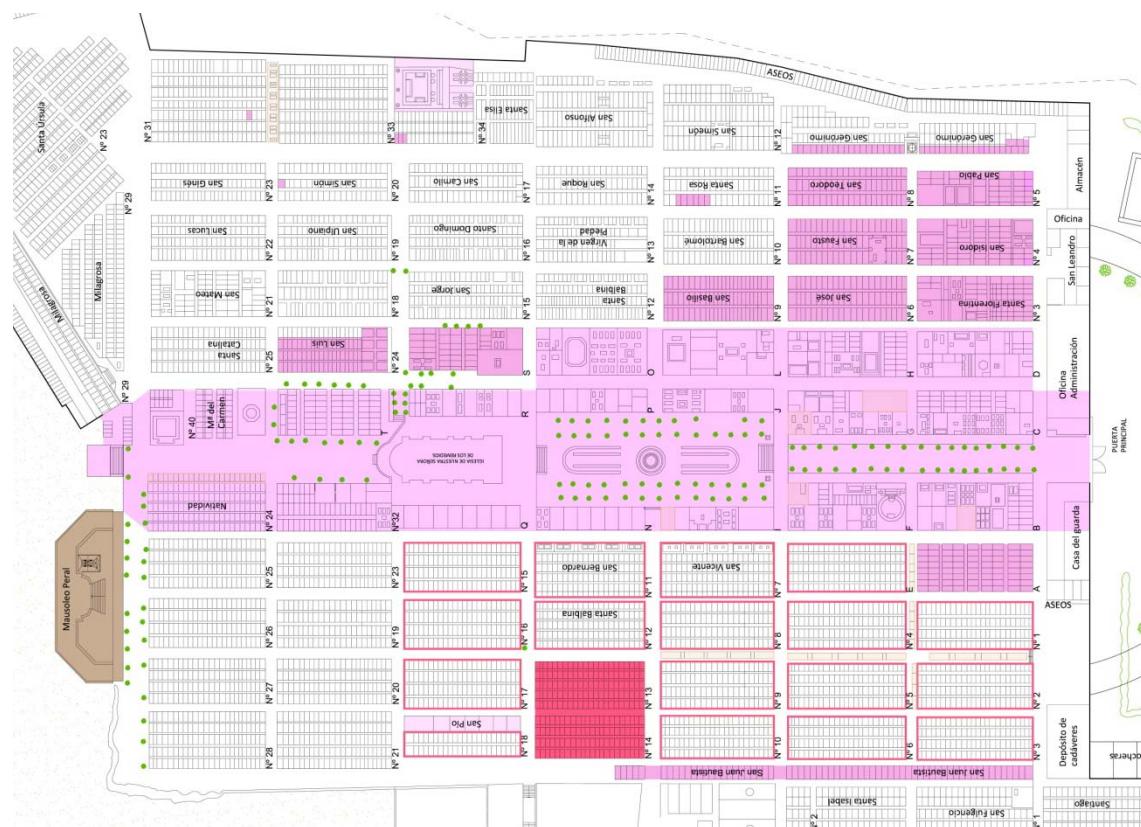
Plano de zonificación establecida por este Plan Director. Elaboración propia. En rosa claro, zona “A”. (Ver punto 3 de este Plan)
